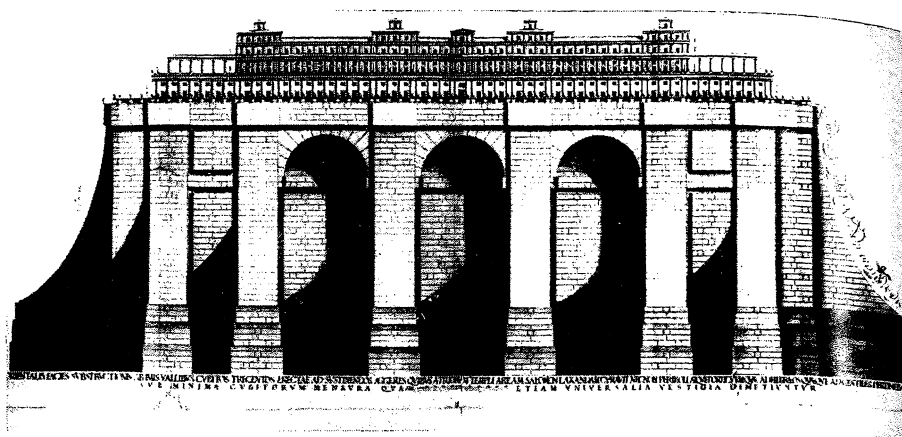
J. B. VILLALPANDO: Reconstrucción de la fachada oriental del templo de Jerusalén (grabado de la obra citada)
